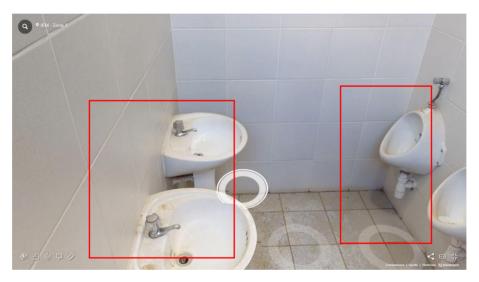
Baño 3.2 (Fisuras)
